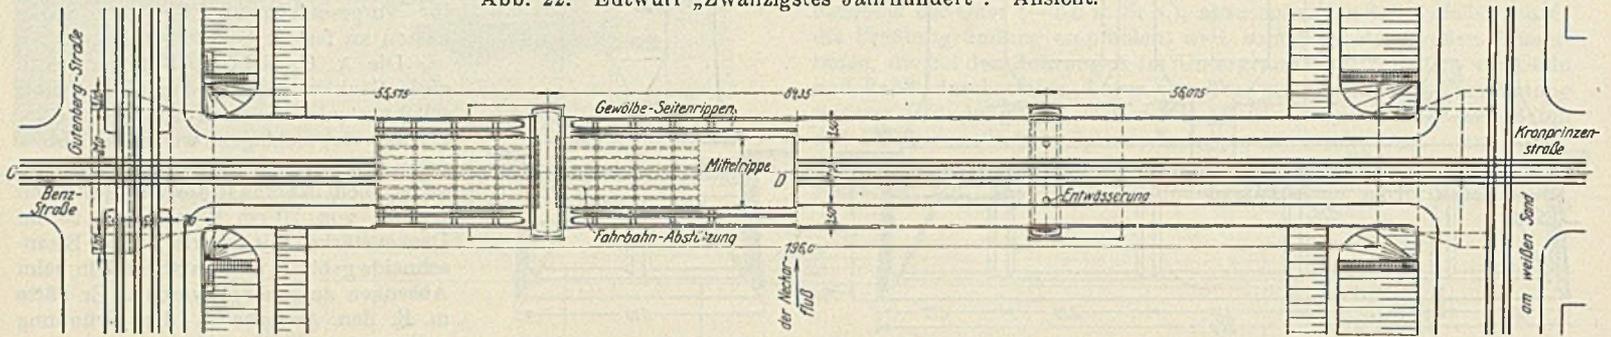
Entwurf „Zwanzigstes Jahrhundert“. Grundriß.
